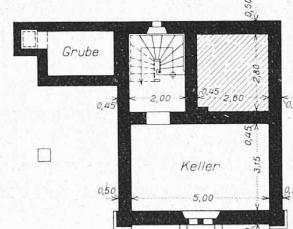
bis 3. Streckenwärter-Wohnhaus. — Grundrisse 1:250.
